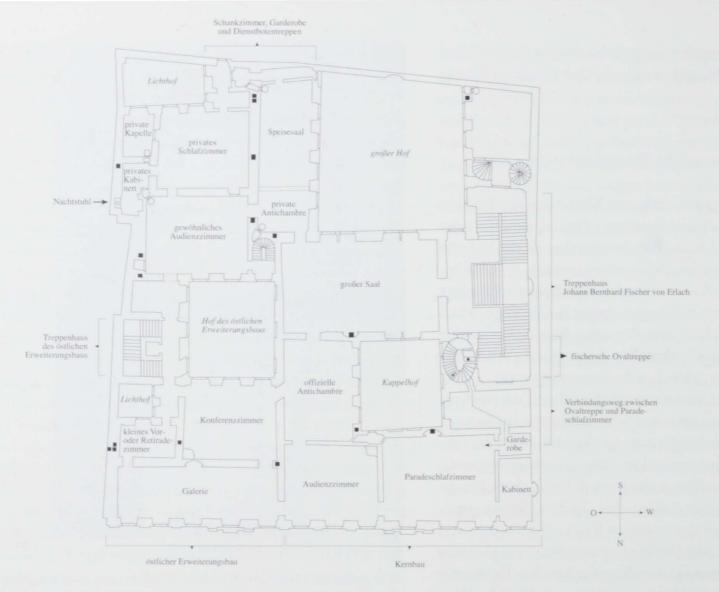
Stadtpalais des Prinzen Eugen, Rekonstruktion des Piano nobile-Grundrisses des Kern- und des östlichen Erweiterungsbaus mit Raumfunktionen
